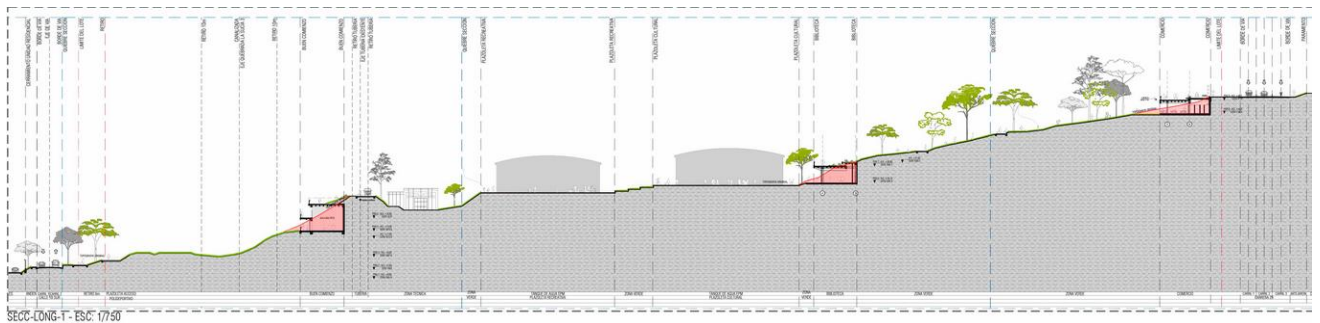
Corte Longitudinal. Fonte: site EPM.
